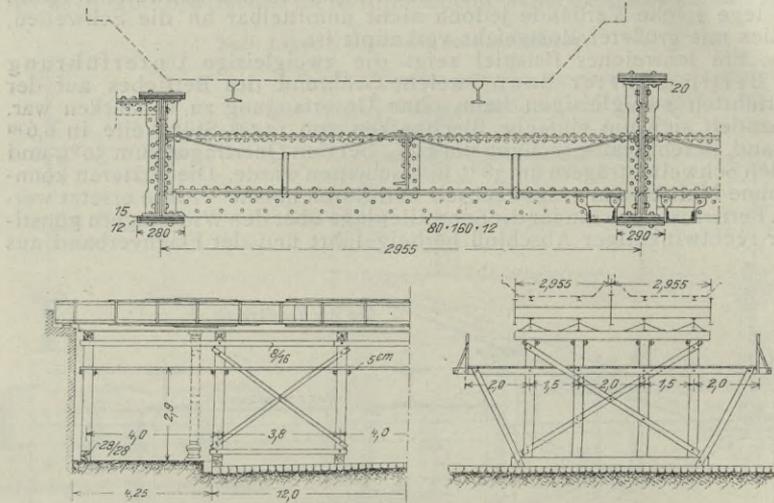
c. Verstärkung einer Straßenbahn-Unterführung in Berlin.
